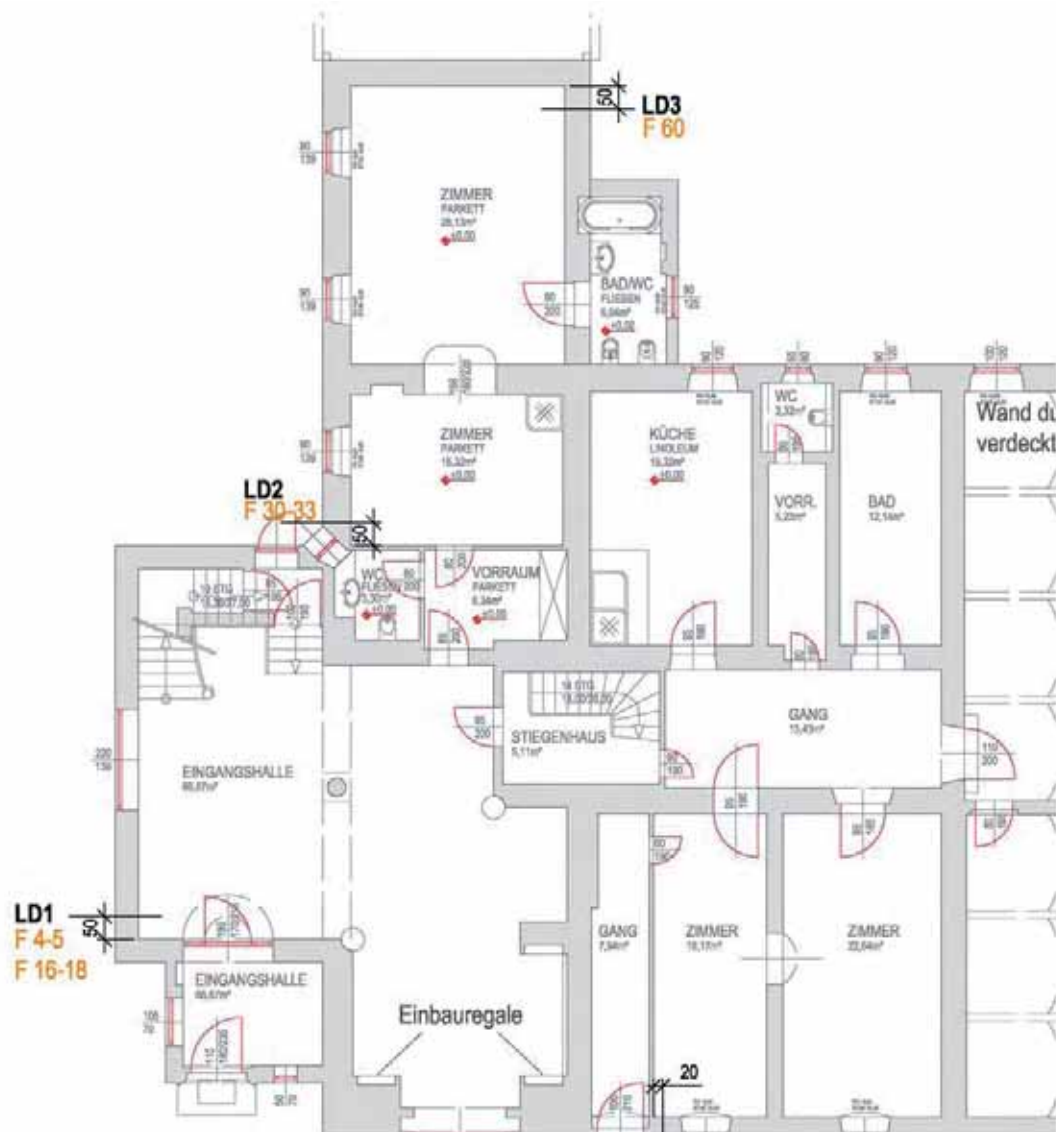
Plan A3 – 1: Position der Achsen 1 (LD 1) bis 3 (LD 3) im Grundriss;
